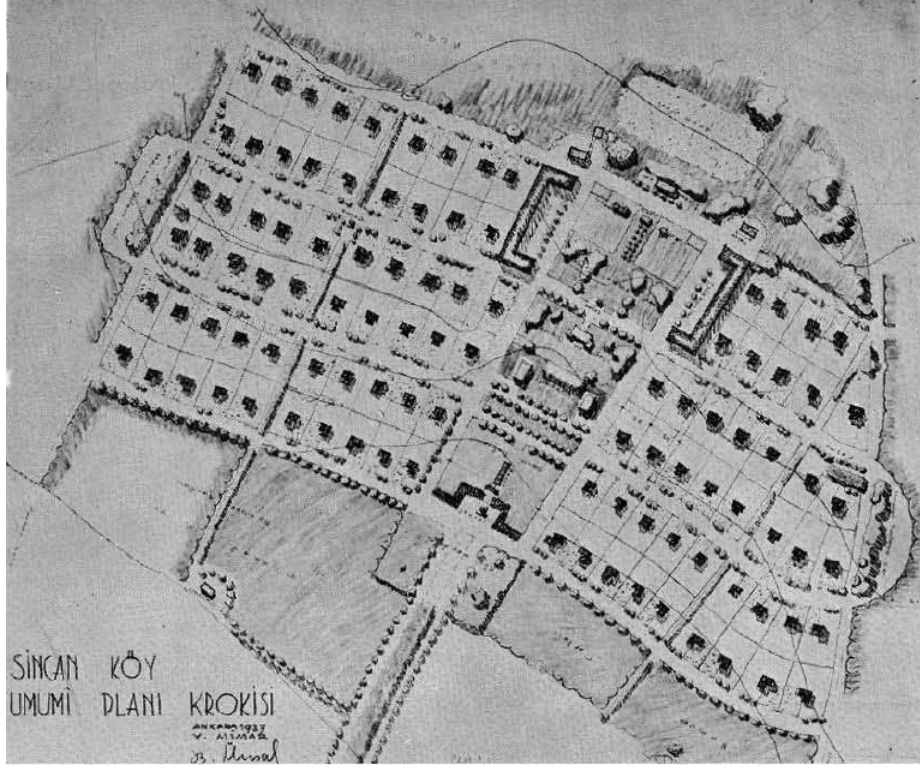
İdeal Cumhuriyet Köyü Planı (İnan,1933).
